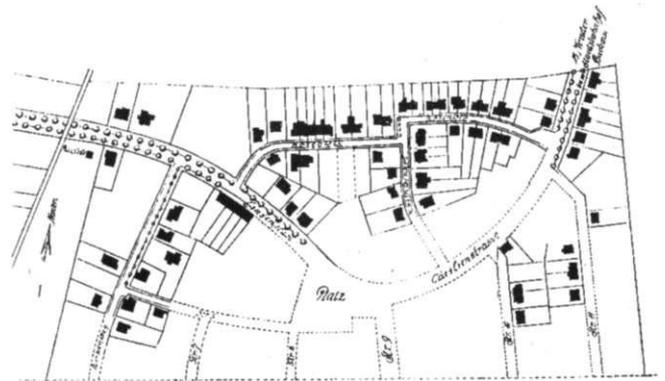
Lageplan der Gartenstadt Hopfengarten, 1911
